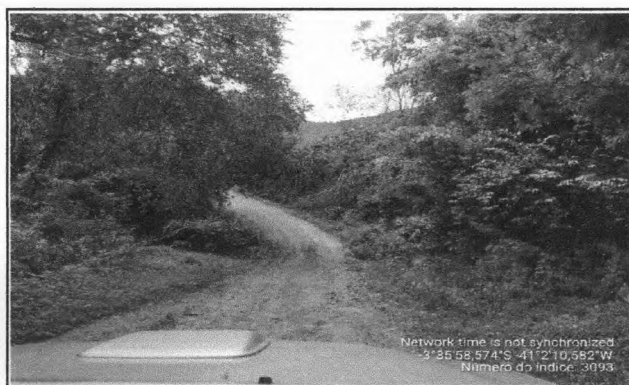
LOCAL DA CONSTRUÇÃO - BUEIRO
